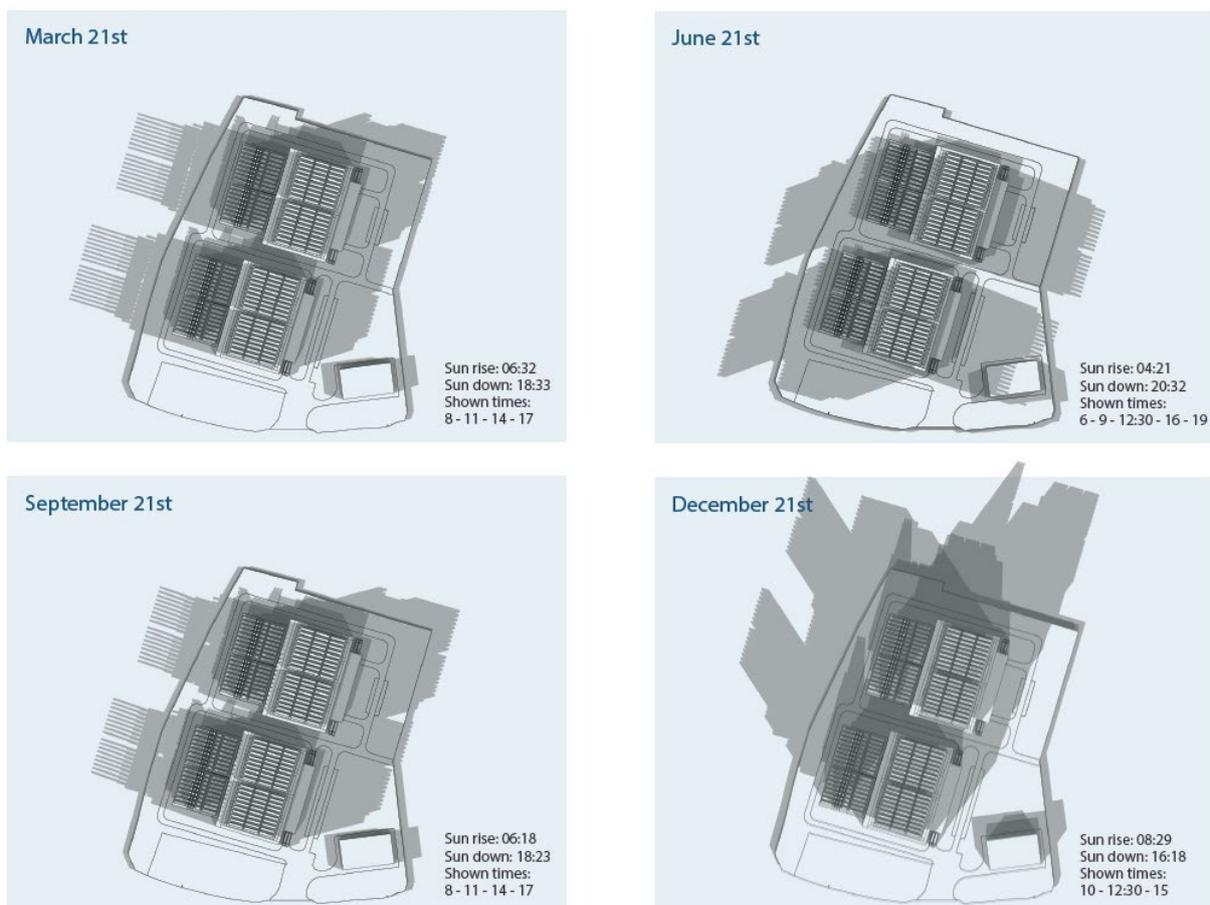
Planungsvariante 1: Verschattung während der maßgeblichen Sonnenstände über das Jahr (21. März, 21. Juni, 21. September und 21. Dezember)
